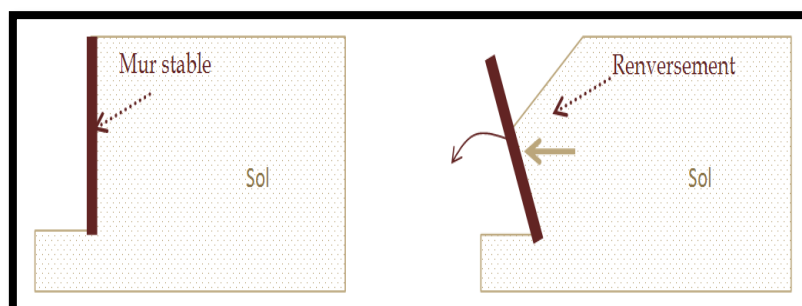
Stabilité au renversement d'un écran de soutènement [3].
